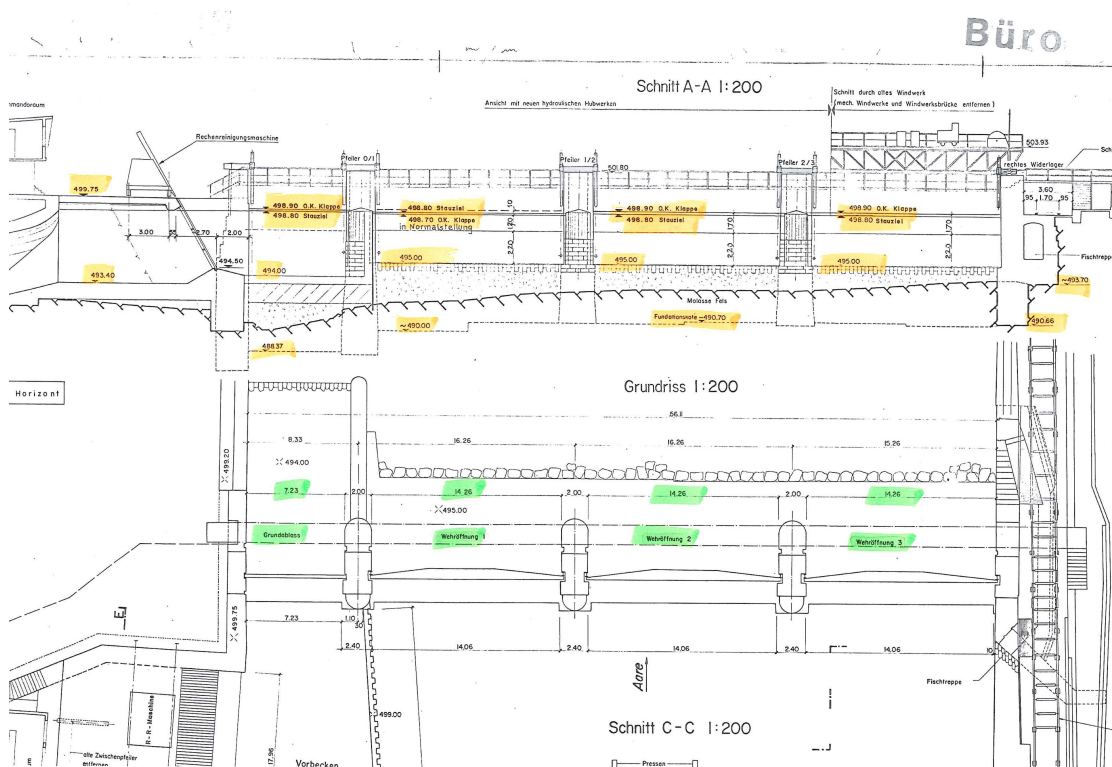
Grundriss und Schnitt der Wehranlage (Darstellung 50 %). Die Koten basieren auf dem alten Horizont und müssen somit um 3.26 m reduziert werden.
